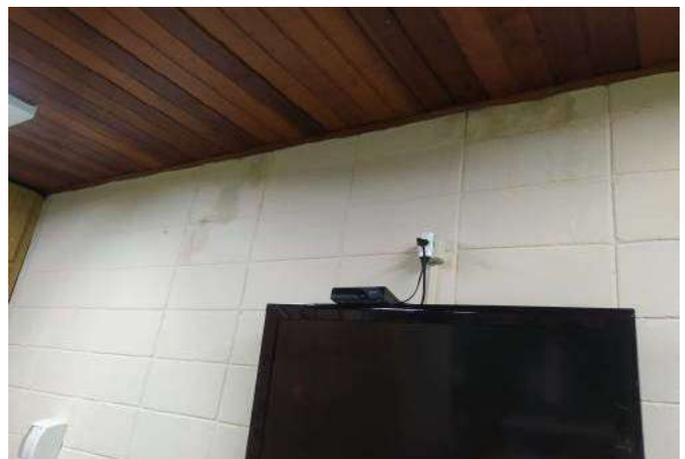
Sala dos professores com varanda, possui infiltração no teto e paredes.
